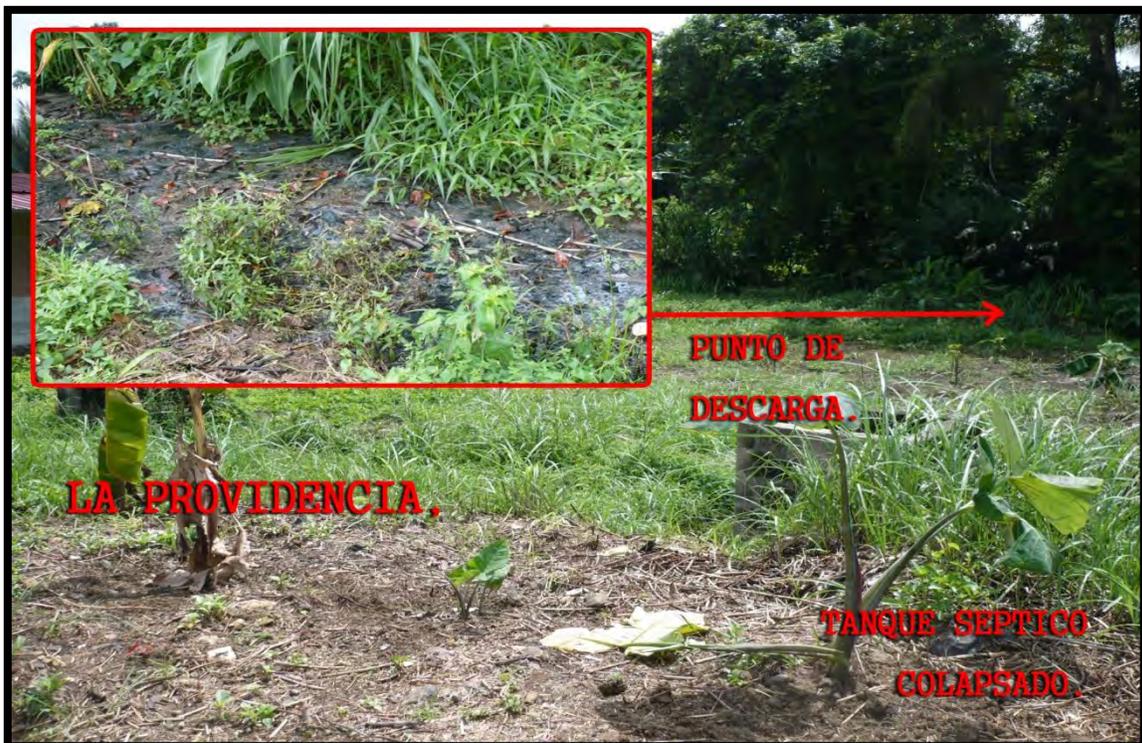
Tanque Séptico No. 1 colapsado en La Providencia.
